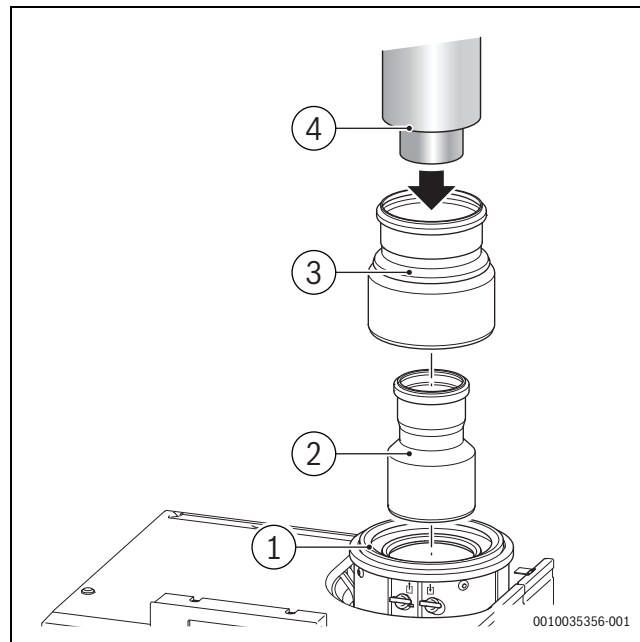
Установка адаптера дымовых газов Ø 80/125
